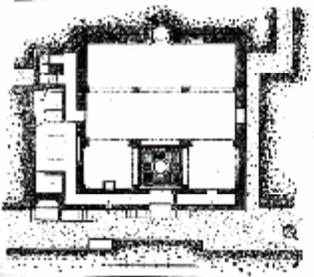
مسقط أفقي لجامع نازة الموحدي
